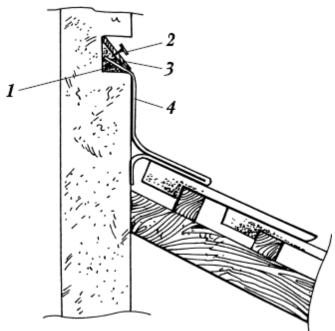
Заделка места примыкания кровли к поперечной стене: 1) раствор; 2) гвозди; 3) закладная рейка; 4) фартук из кровельной стали
